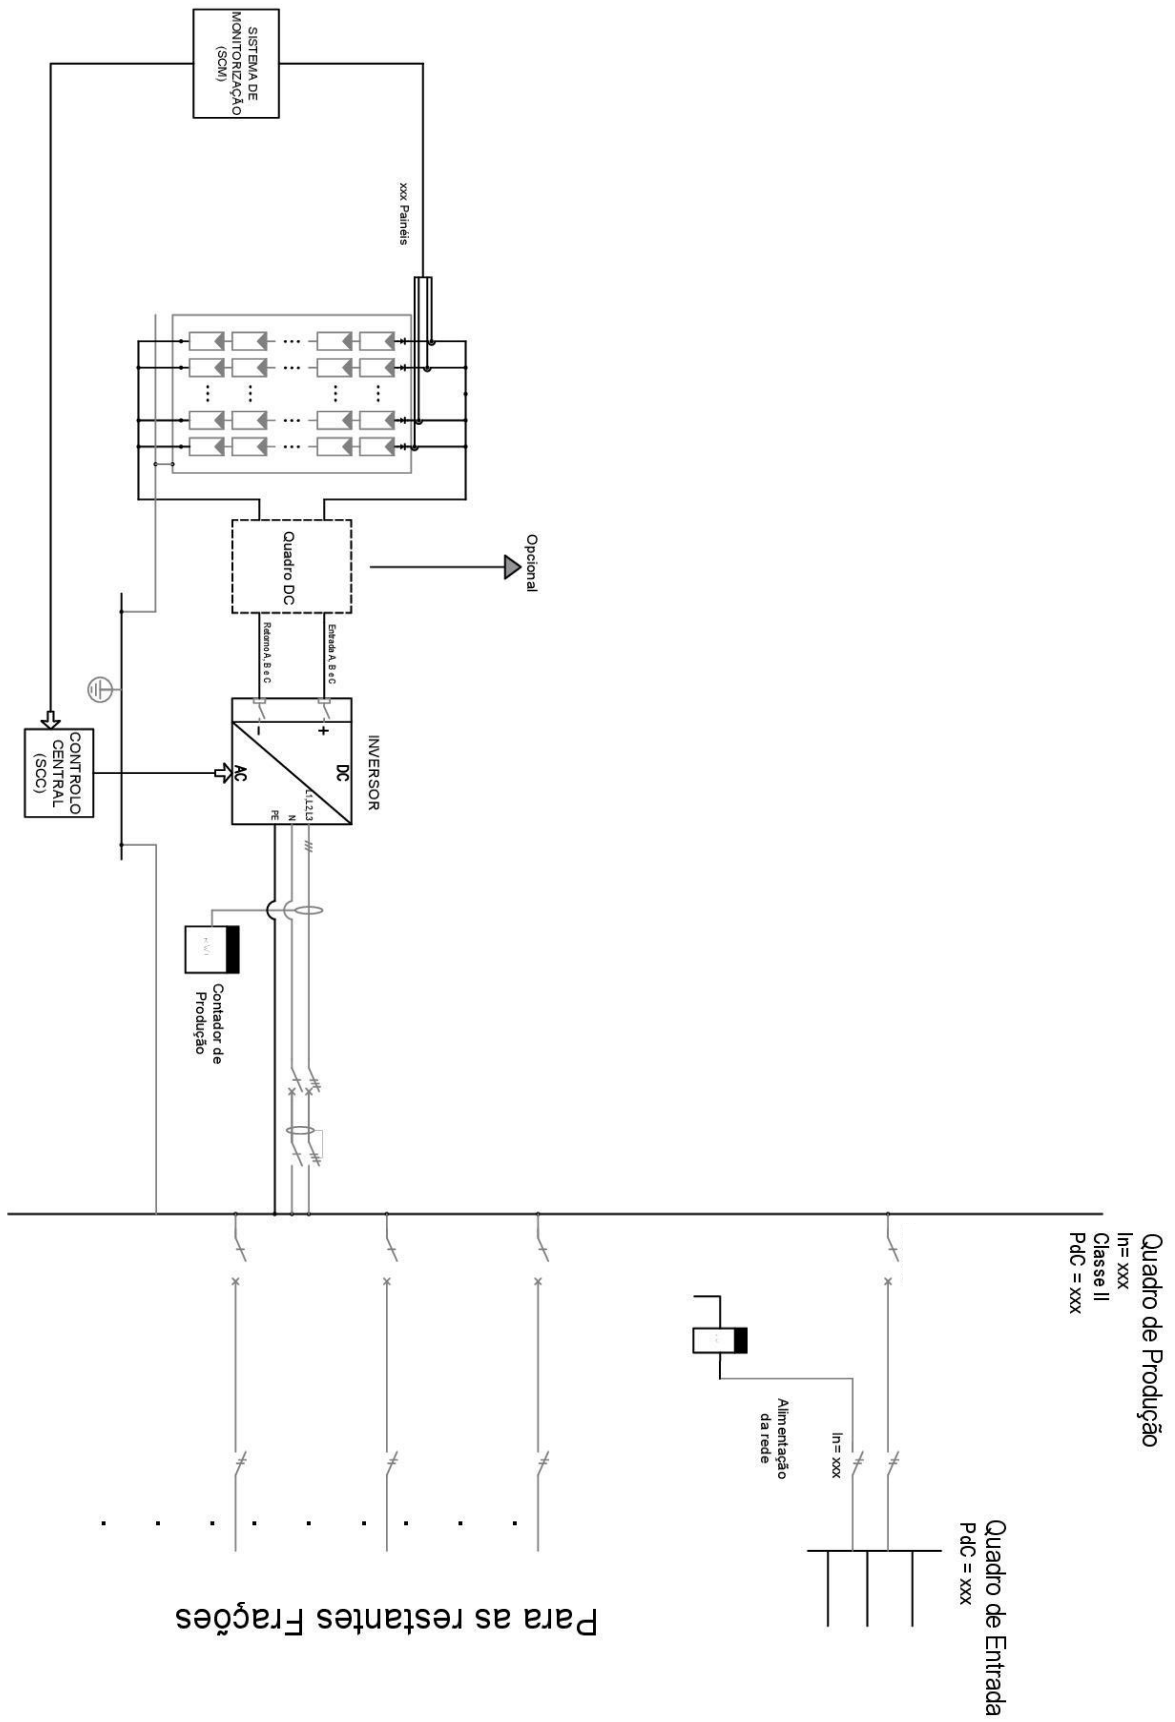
Pormenor da ligação entre a UPAC e as frações de um prédio.
